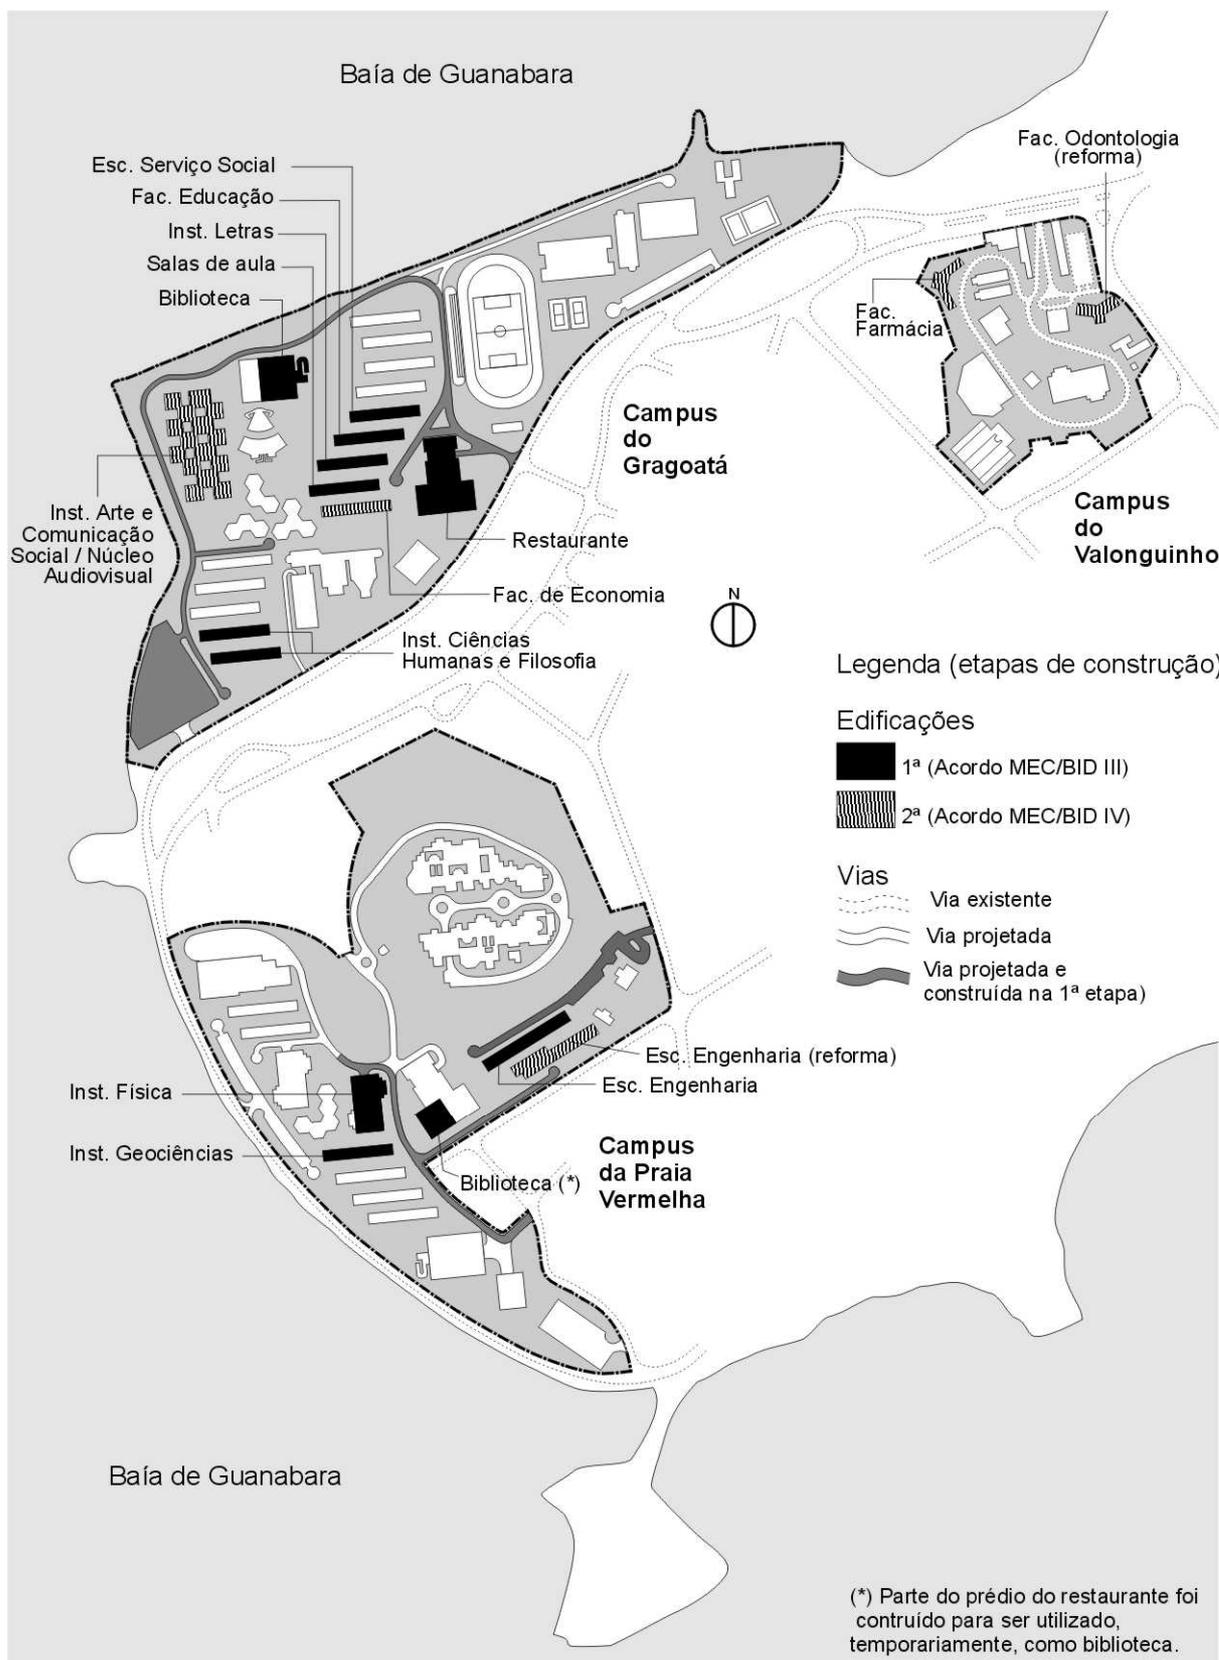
Planta de situação do Campus da UFF: etapas de construção (Planta esquemática, sem escala).
